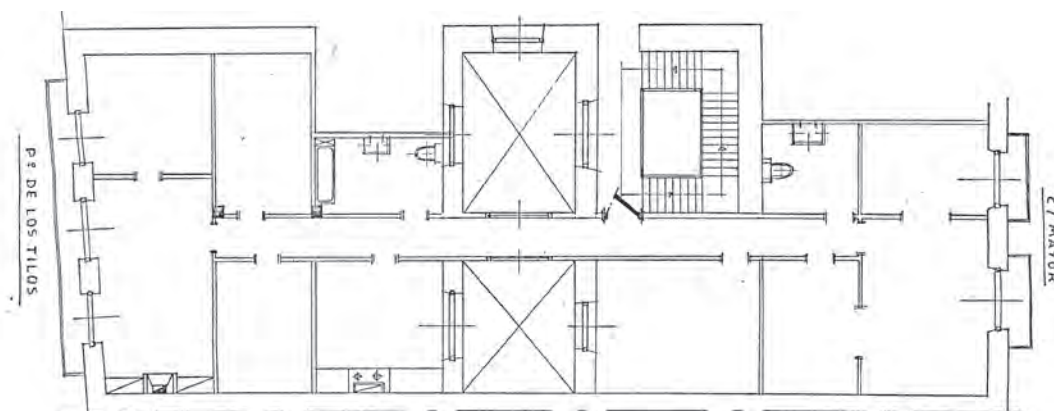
37. PLANO DEL ESTADO DE LA VIVIENDA 2º A EN 1984²⁷
